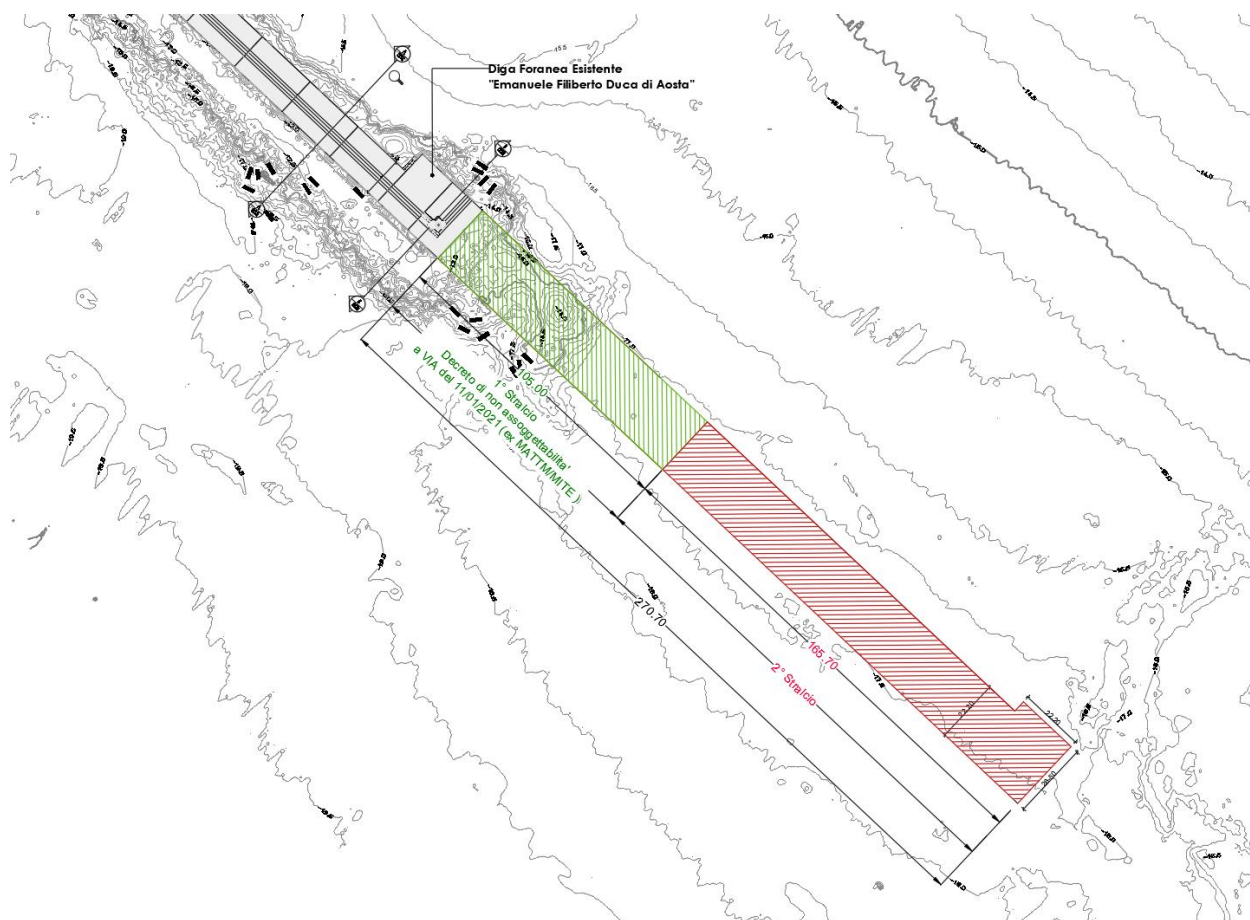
1 Planimetria dello stato di fatto con l'area di intervento
